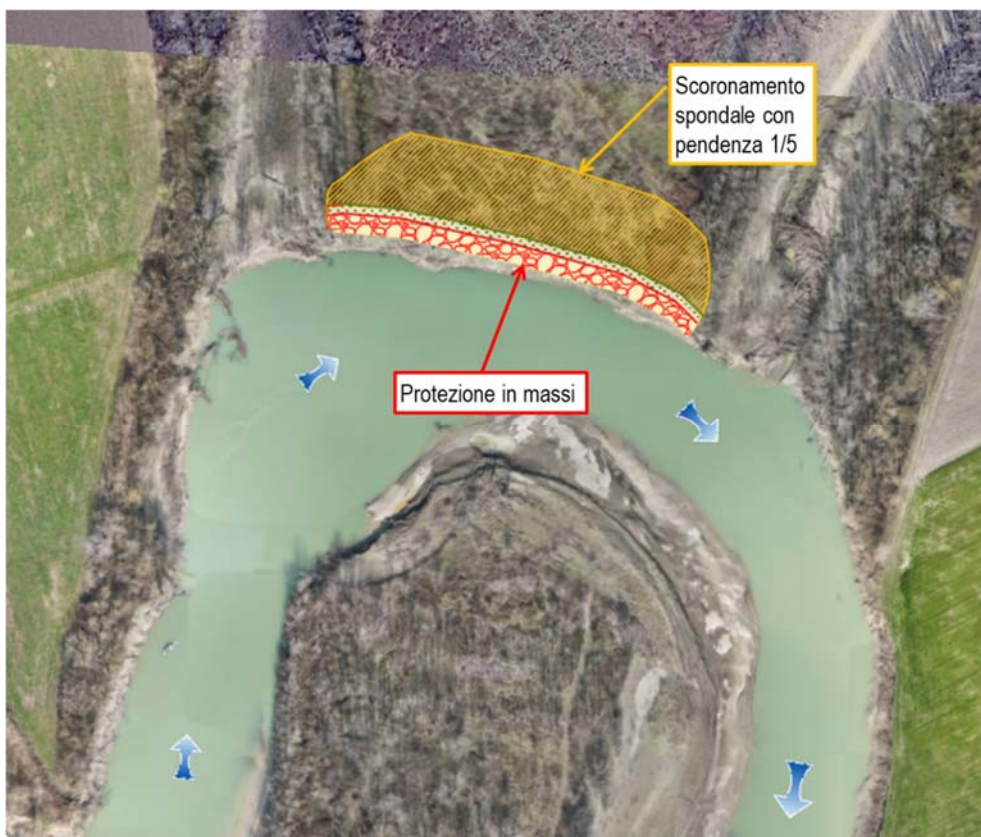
Estratto Tav.PFTE.12 – Planimetria Opera 2
